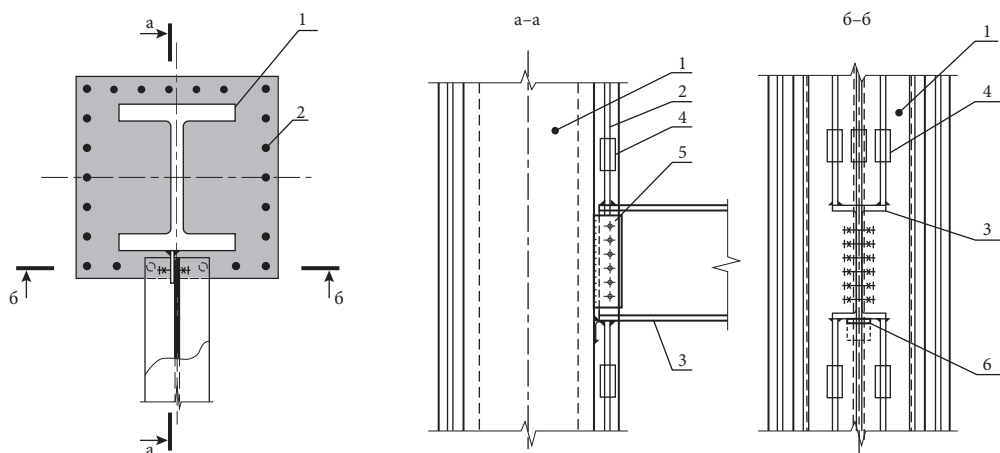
Узел примыкания стальной балки к жесткой арматуре сталежелезобетонной колонны через стальной флажок (хомуты и шпильки условно не показаны). 1 — жесткая арматура, 2 — гибкая арматура, 3 — стальная балка, 4 — соединительная муфта гибкой арматуры, 5 — флажок, 6 — монтажный столик
